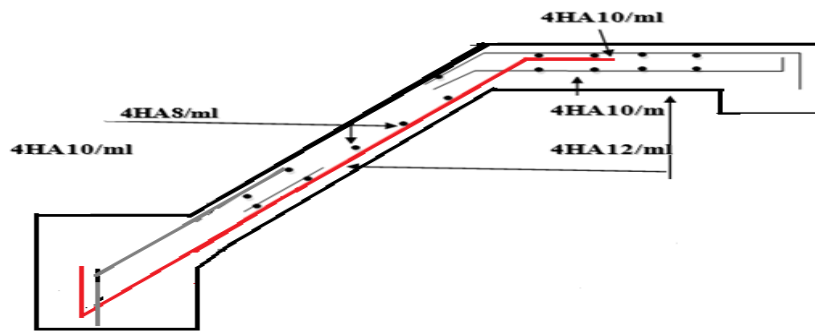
schéma de ferrailage de l'escalier (étage).
